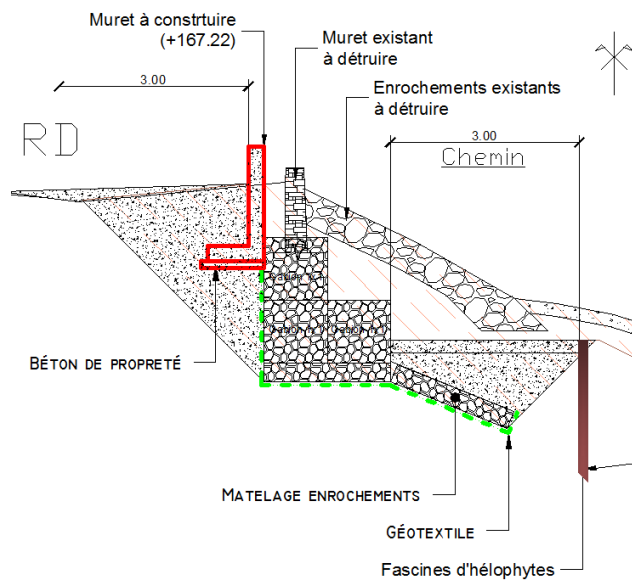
Coupe type de la digue RD à l'aval de la passerelle Chabrières à Oullins
